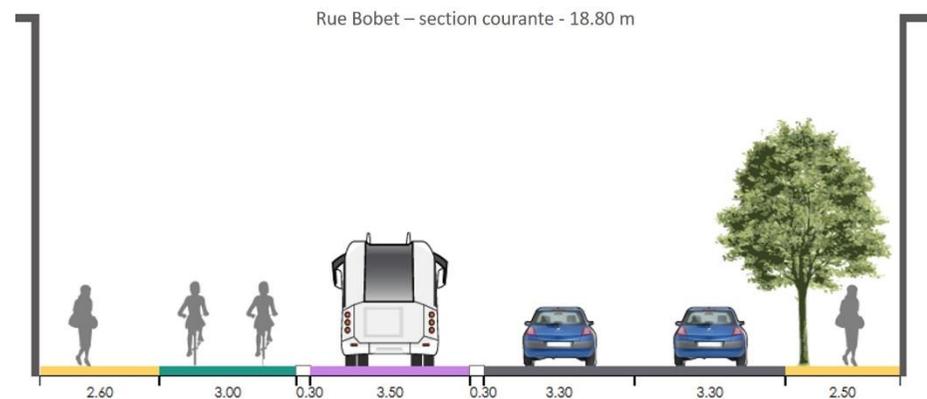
Coupe 1B-1 - projet de l'avenue Louison Bobet
